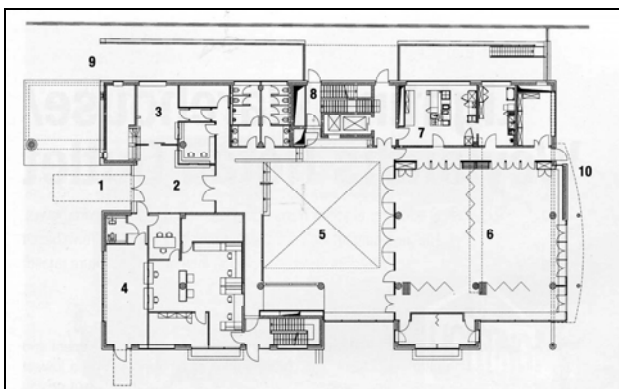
Grundriss des Erdgeschosses der südafrikanischen Botschaft (MMA ARCHITECTS)
